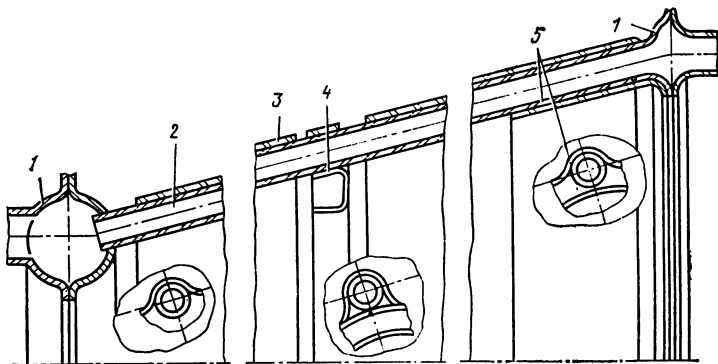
Конический жесткий неразвертывающийся излучатель
